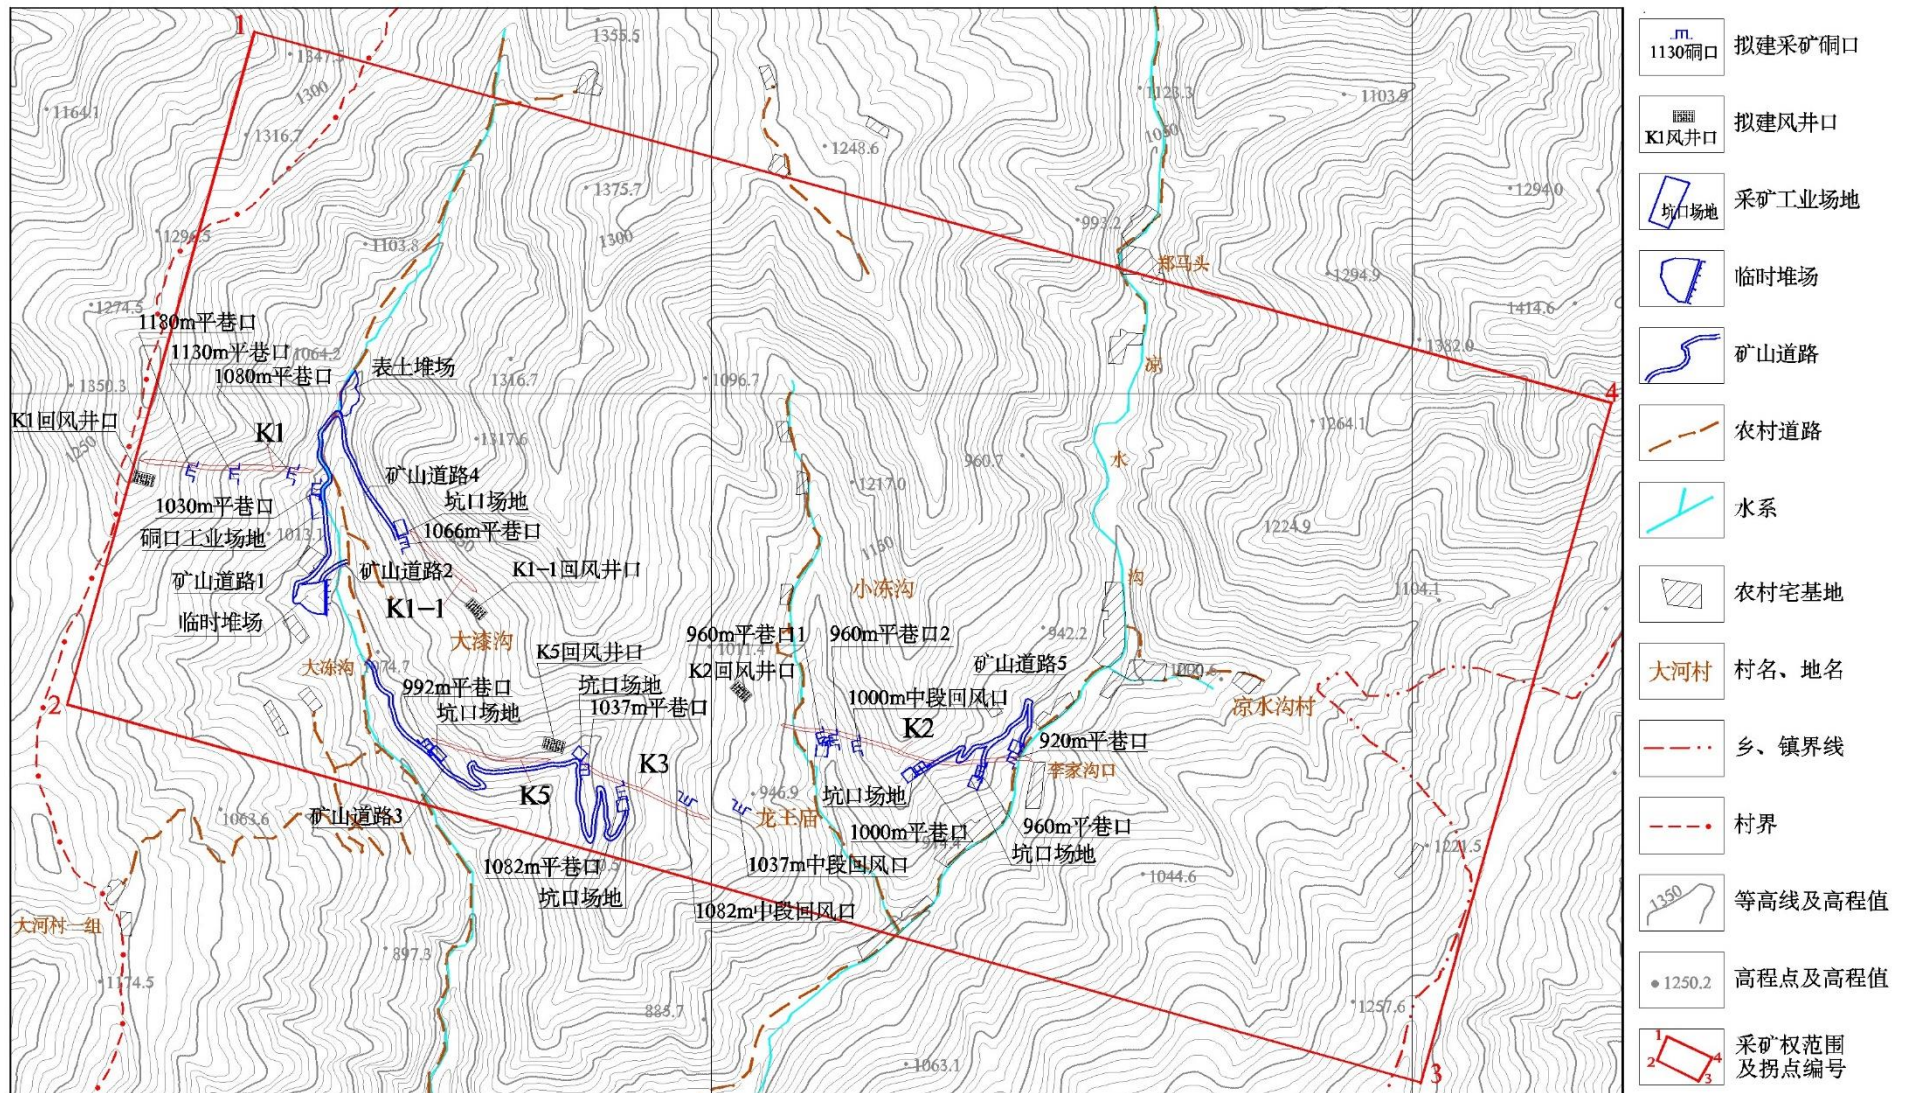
凉水沟银铅矿矿山工程平面布置示意图
